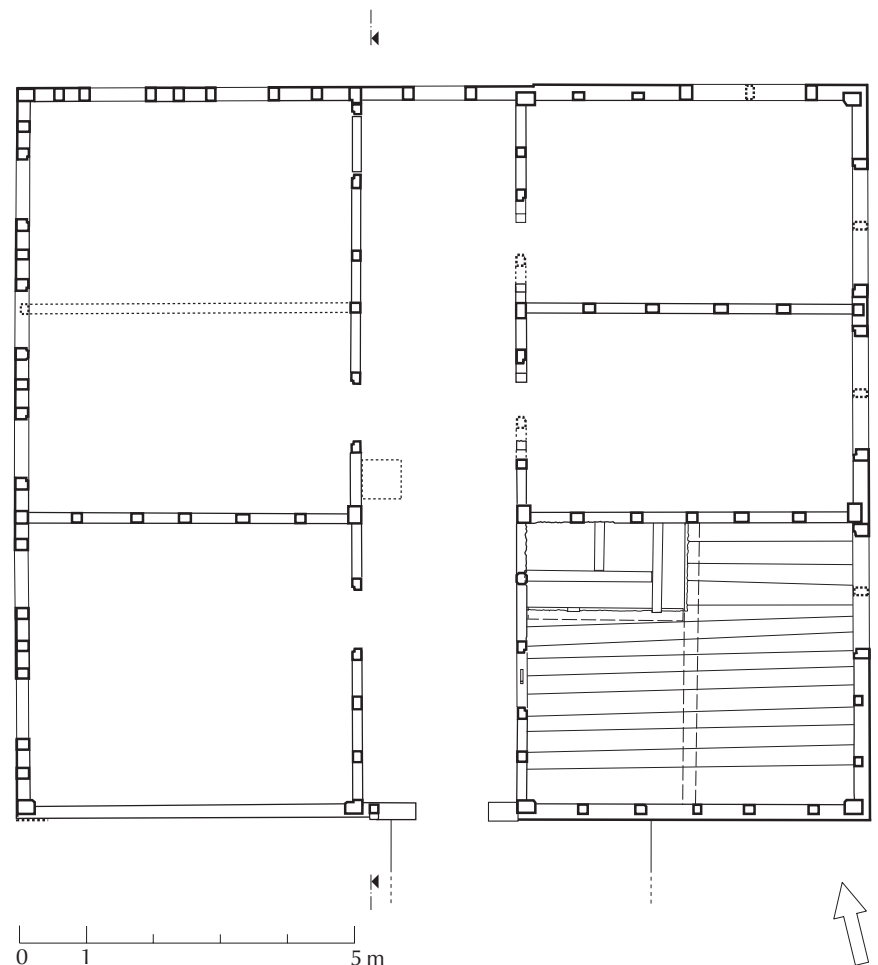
Grundriss des zweiten Wohngeschosses.
